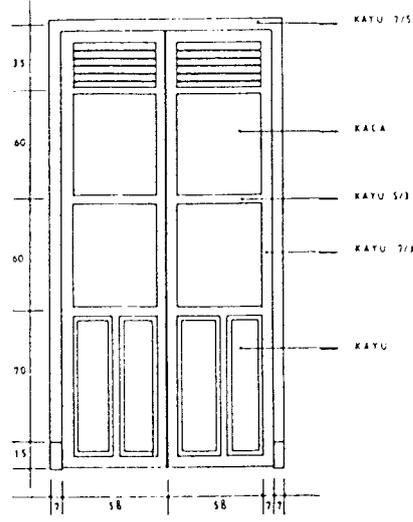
DETAIL JENDELA BANGUNAN KOLONIAL OMAH DHUWUR GALLERY
